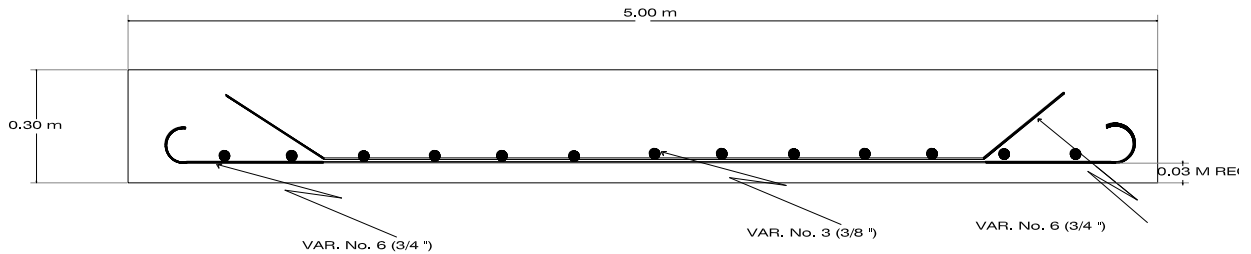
Armado de la losa (corte Lado Corto).
